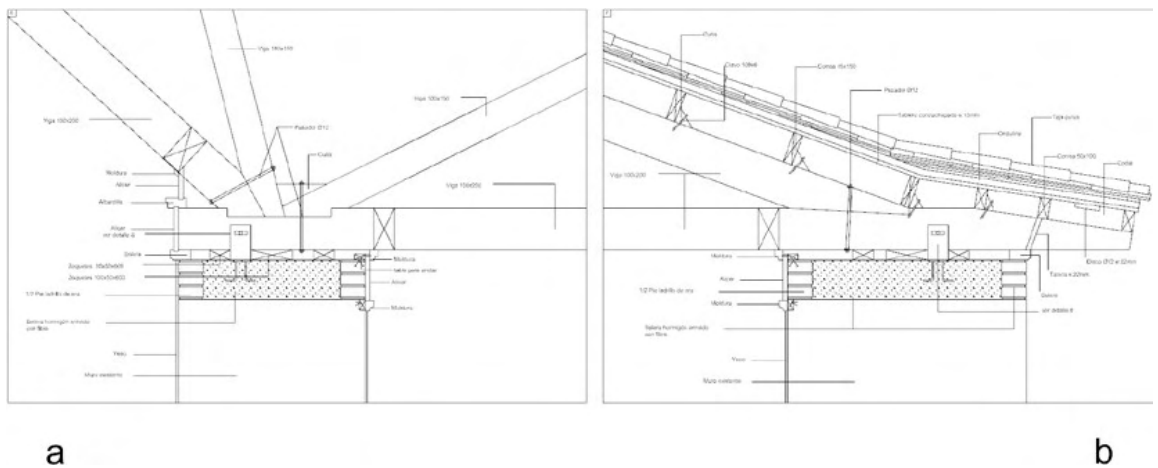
Detalle constructivo de los apoyos en deslizamiento sobre muros de fábrica.
